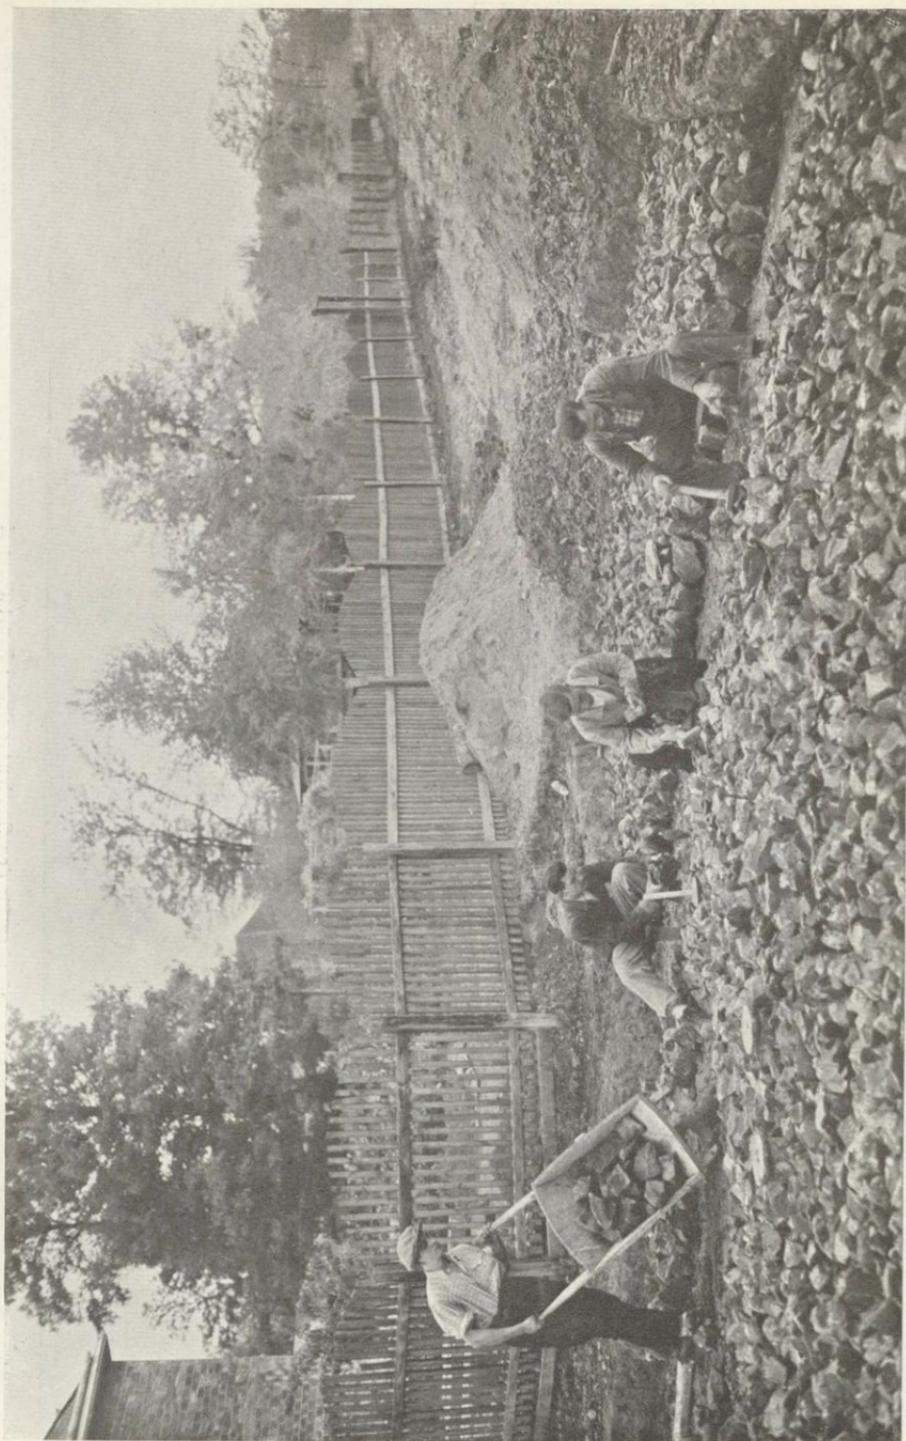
Freiwilliger Arbeitsdienst: Straßenbau für den Siedlungsaufbau; Baustadium I
